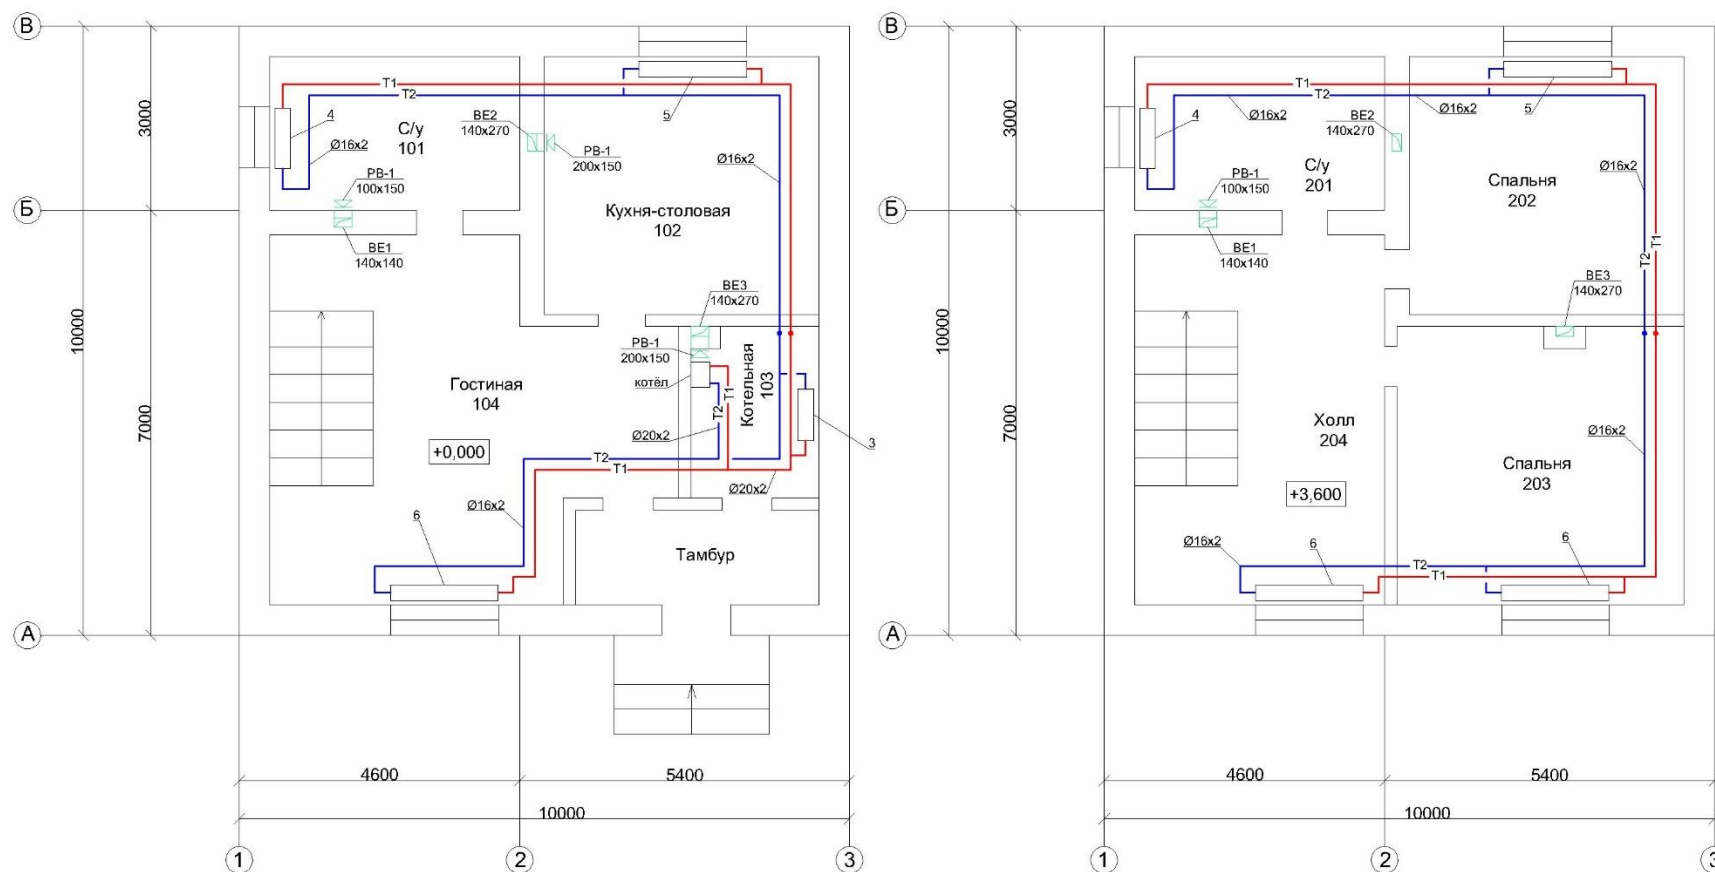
Планы этажей с нанесением систем отопления и вентиляции
